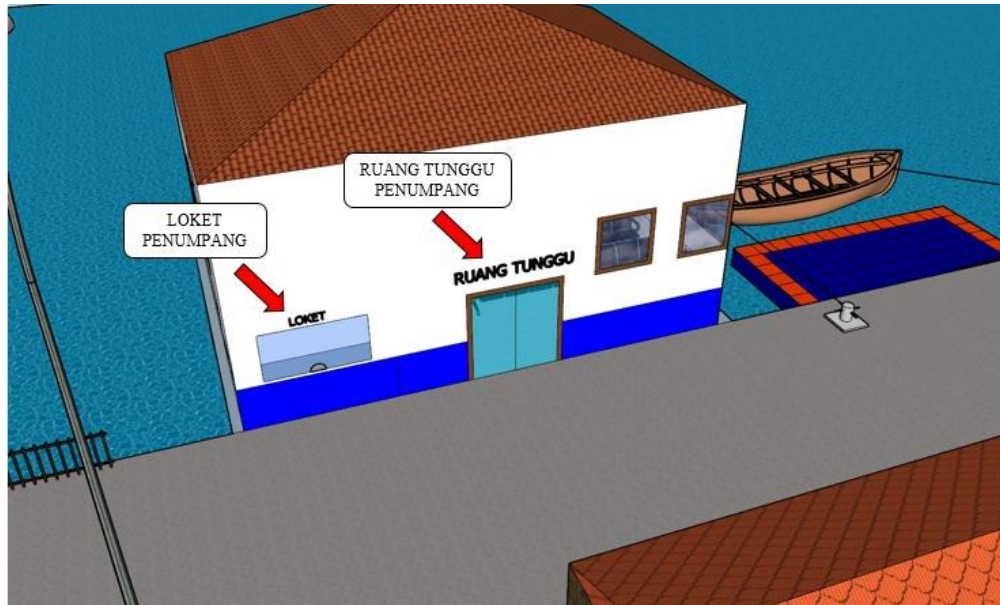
Layout* Kondisi Fasilitas Ruang Tunggu yang baru
